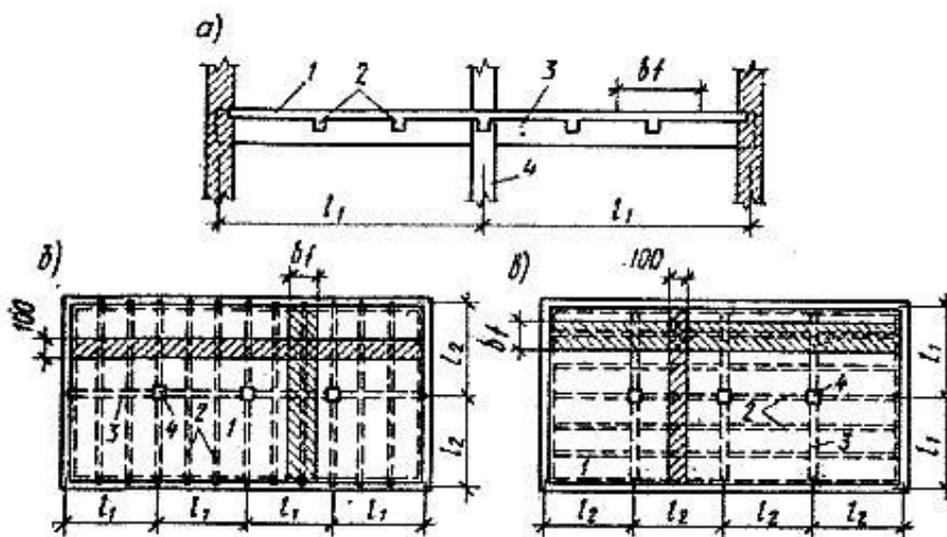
Конструктивные схемы монолитных ребристых перекрытий с балочными плитами
